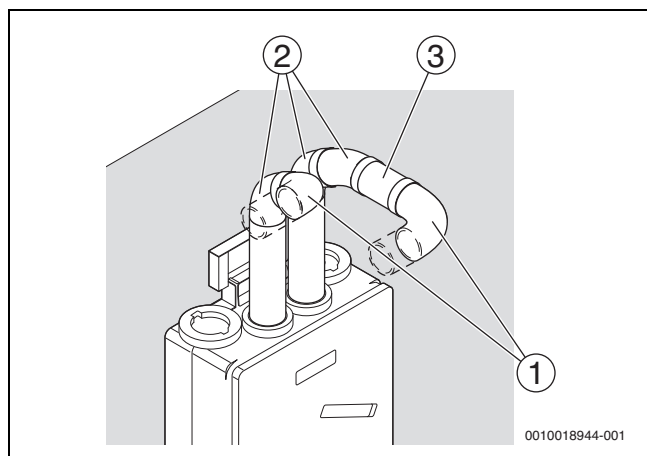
Dettagli di collegamento per fig. da 36 a 38: disposizione dei tubi aria adduzione/ripresa
